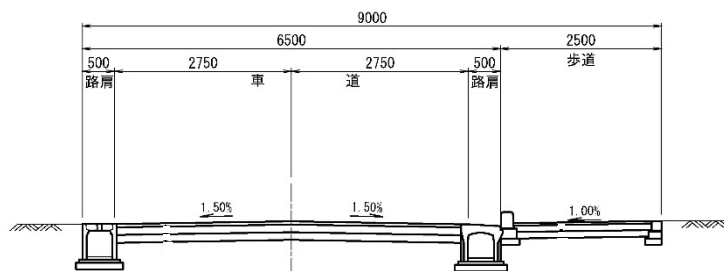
(4) 標準断面図 (区画道路 幅員 9.0m)
